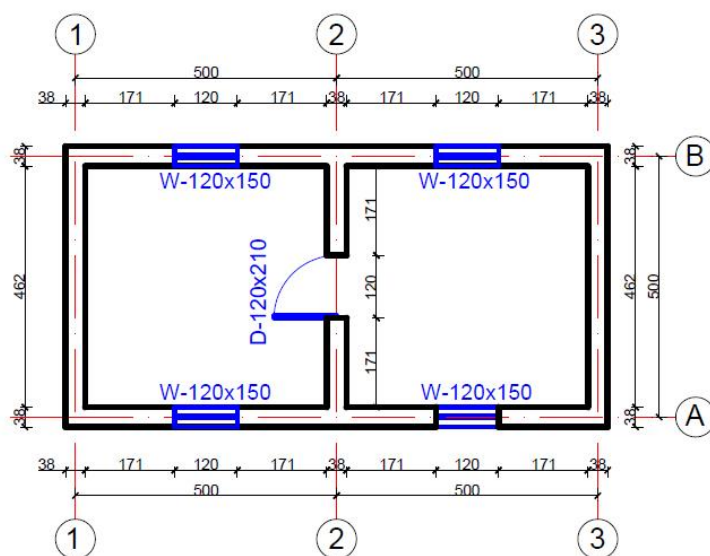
Planimetri e katit të parë të strukturës së testuar.
